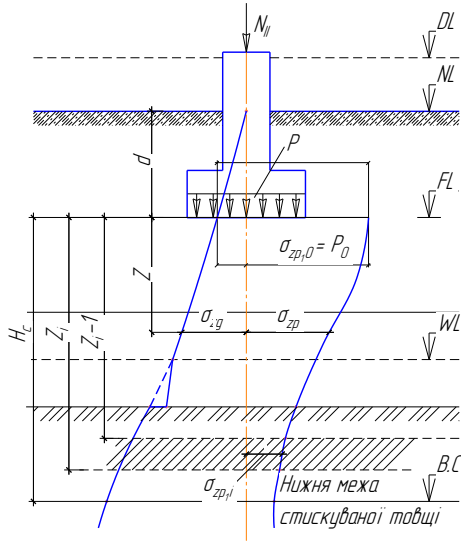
Схема до розрахунку осідання методом пошарового підсумовування
